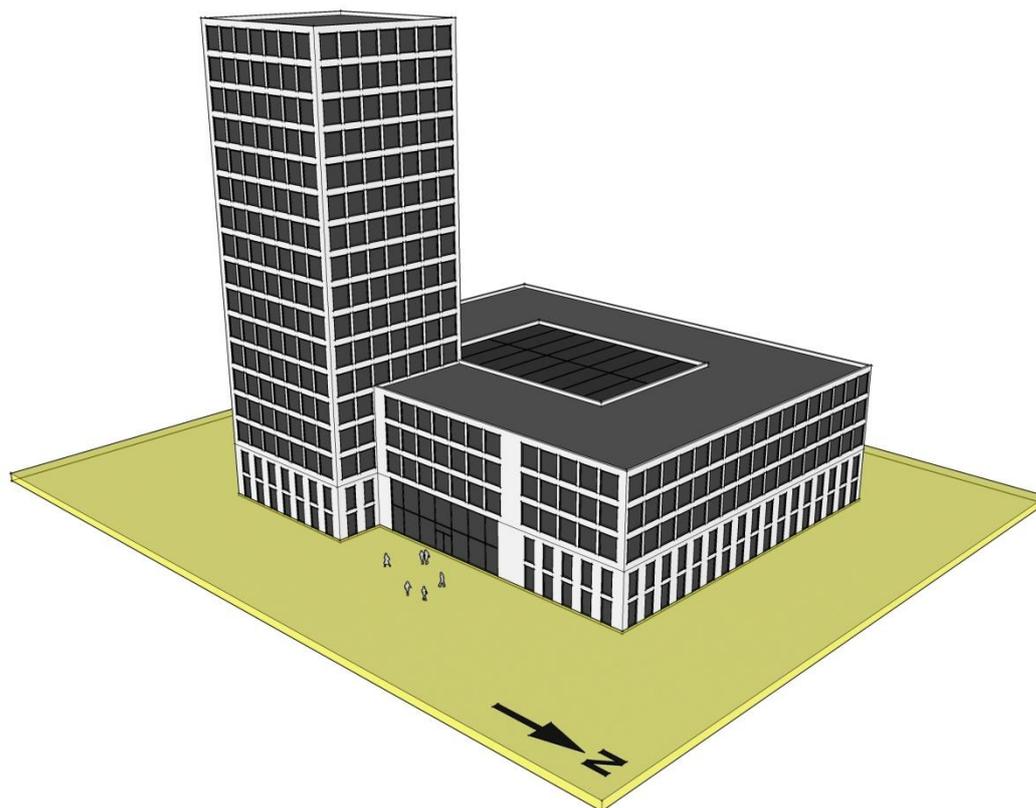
Büros – Module – Atrium & Turm - Darstellung Gebäude – Ansicht Nord-Ost
